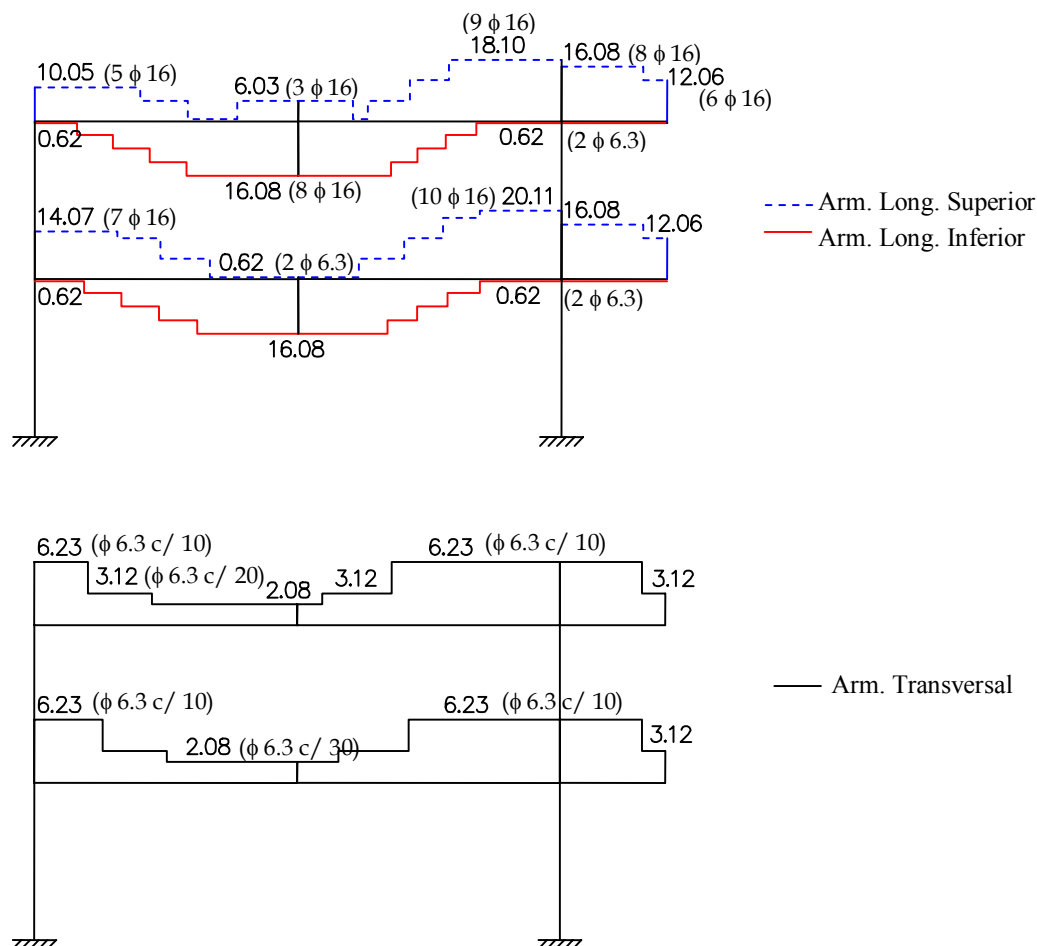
Diagramas de armadura adotada para o pórtico do Exemplo 3.
